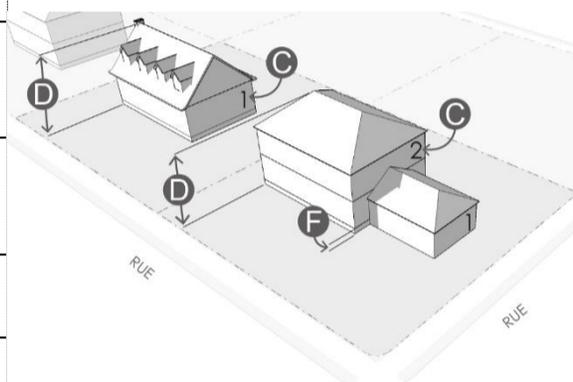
Hauteur d'un bâtiment et du plancher du rez-de-chaussée
